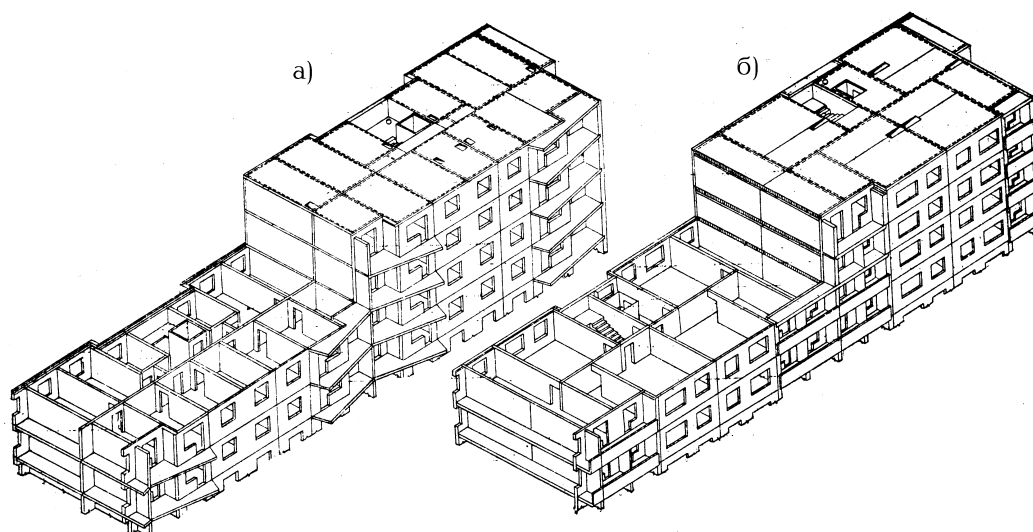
Бескаркасные конструктивные системы панельных зданий массового применения: а -перекрестно - стенная с малым шагом поперечных стен; б - поперечно - стенная со смешанным шагом
